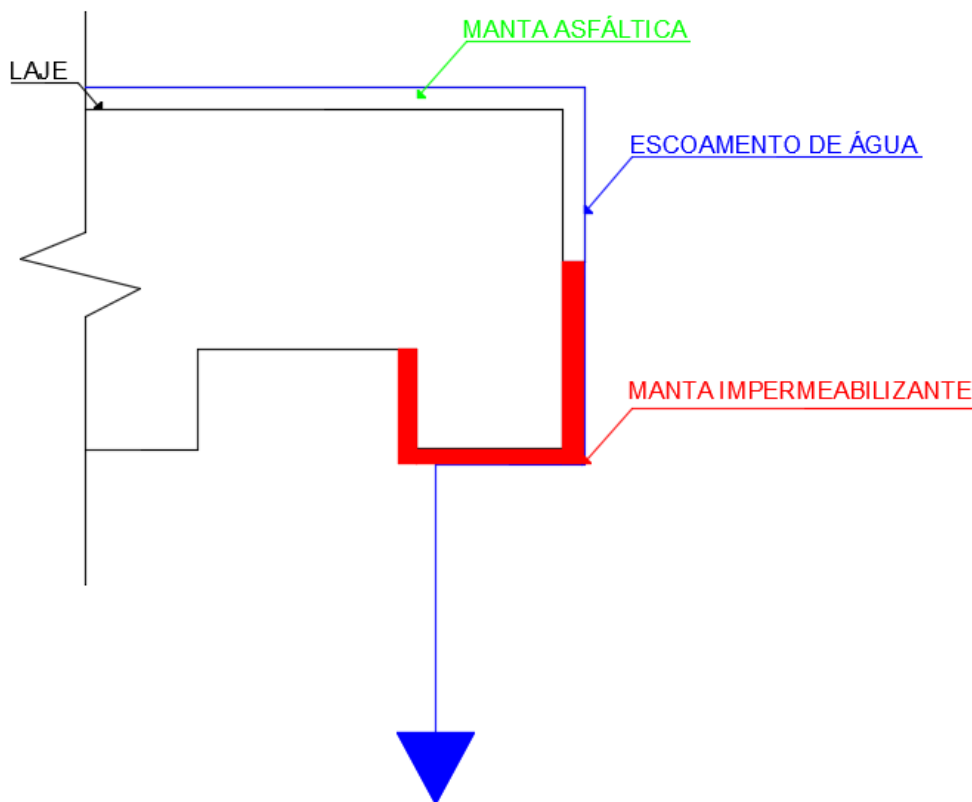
Seção transversal da pingadeira após a aplicação da manta impermeabilizante
